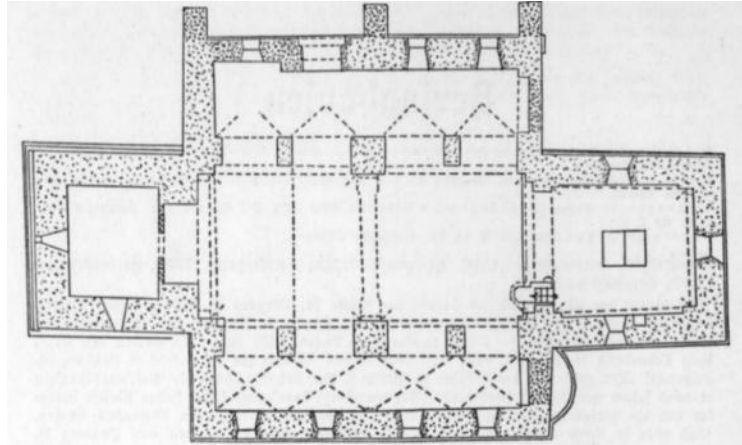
Kirche in Heringhausen – Grundriss [1]
